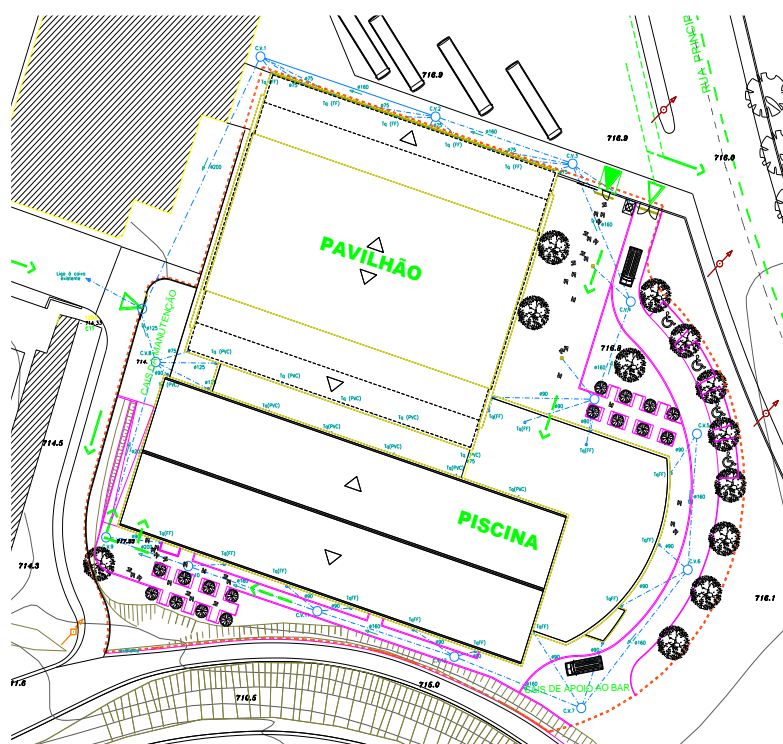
Plantas de cobertura das piscinas e pavilhão municipal.
